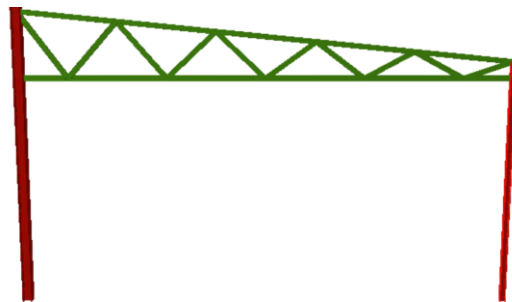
Pórtico tipo de la estructura auxiliar. Fuente: Propia
